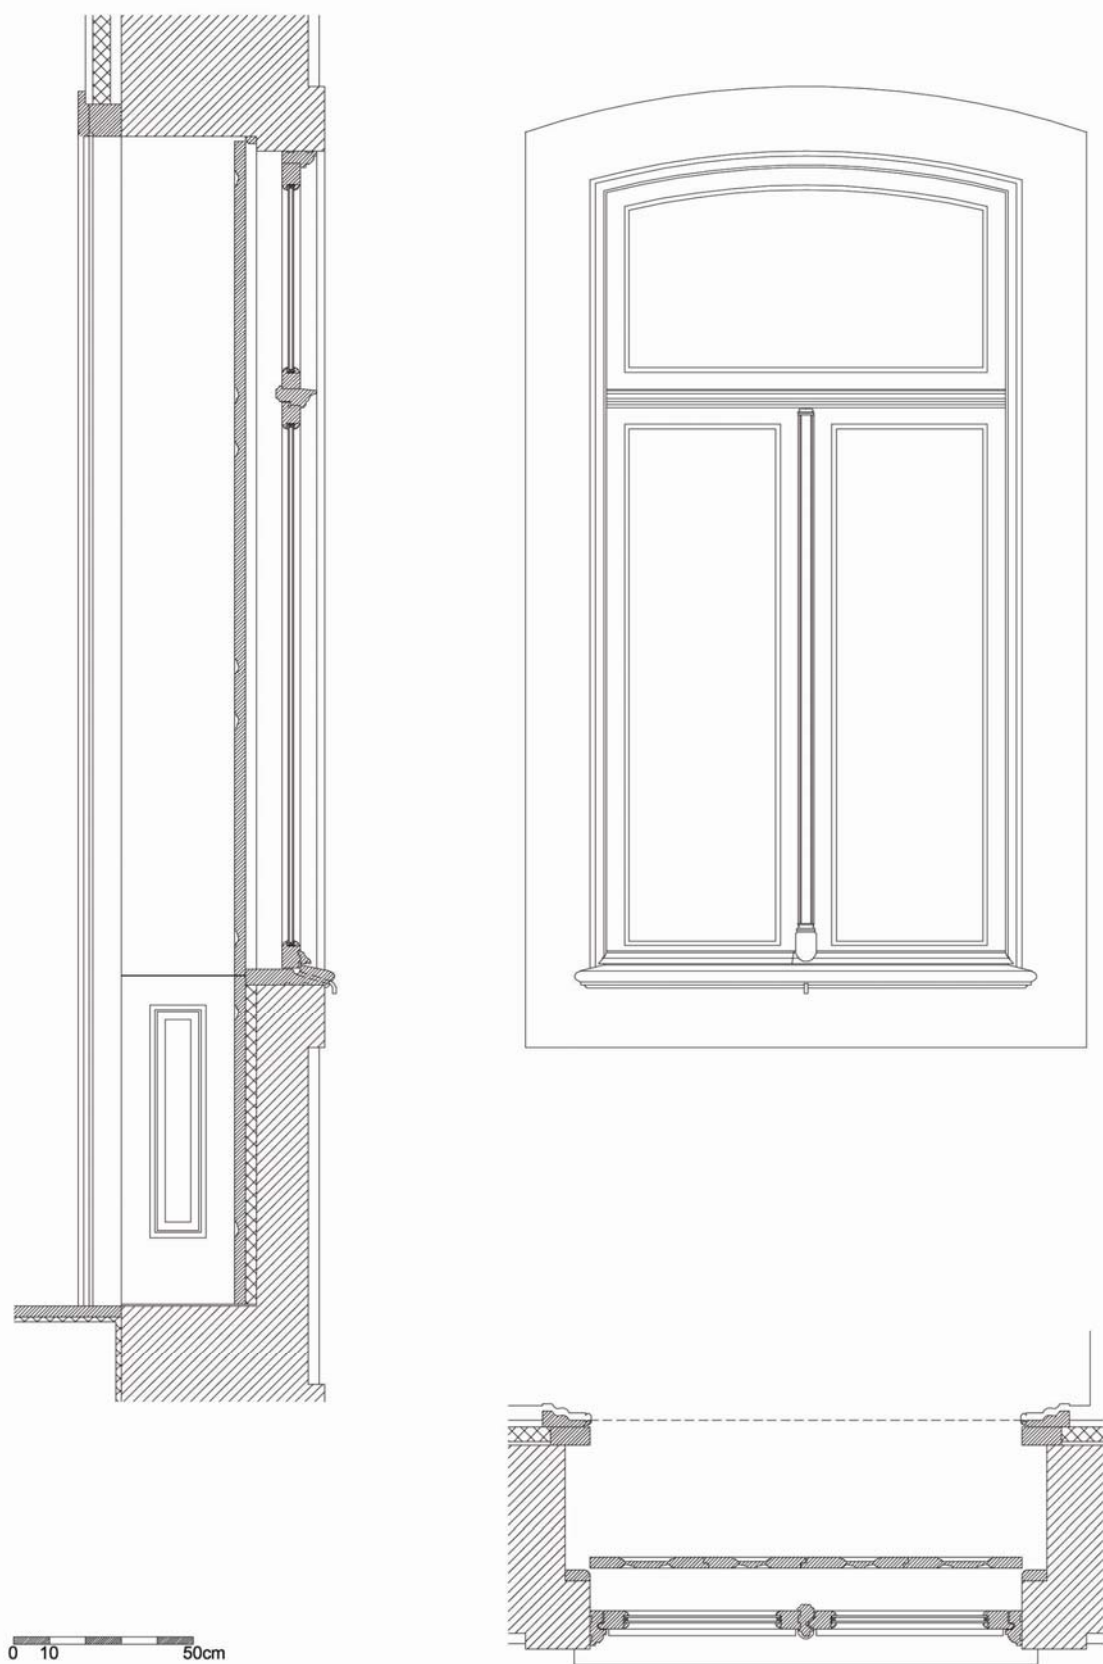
Substituição da caixilharia existente por uma nova caixilharia (re) interpretando o desenho original - corte vertical, corte horizontal e alçado exterior.
